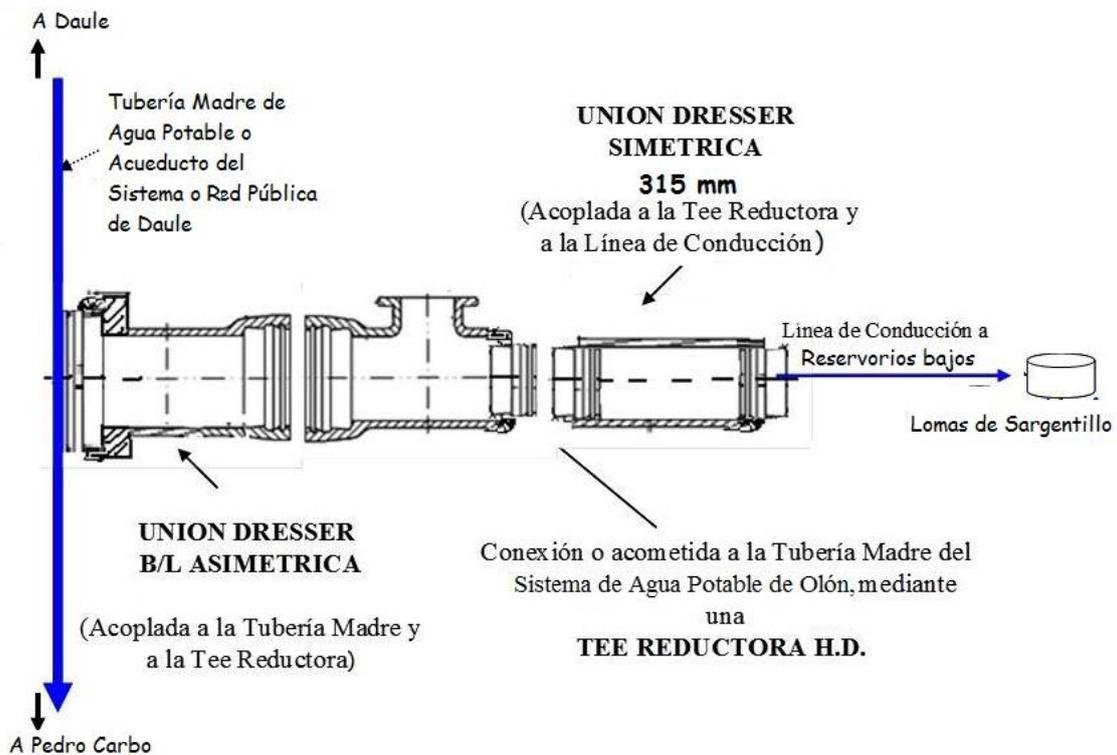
Conexión al Acueducto del Sistema de Agua Potable de Daule, mediante una Unión Dresser Asimétrica que se ensambla a una Tee Reductora HD, acoplada a una Unión Dresser, para empatar con la Tubería o Línea de Conducción. Este punto es el inicio del Sistema de Agua Potable de Lomas de Sargentillo en el sector conocido como Puente "Icaza Cornejo"
